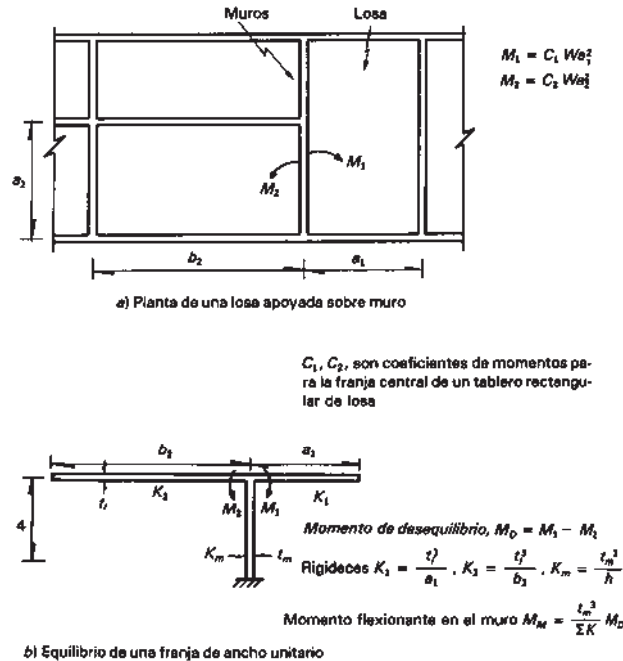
Determinación aproximada del momento flexionante en un muro con sistema de cubierta plana
